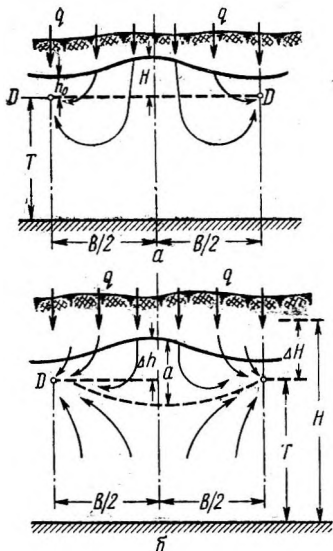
Схема отвода грунтовых вод горизонтальным дренажем :
